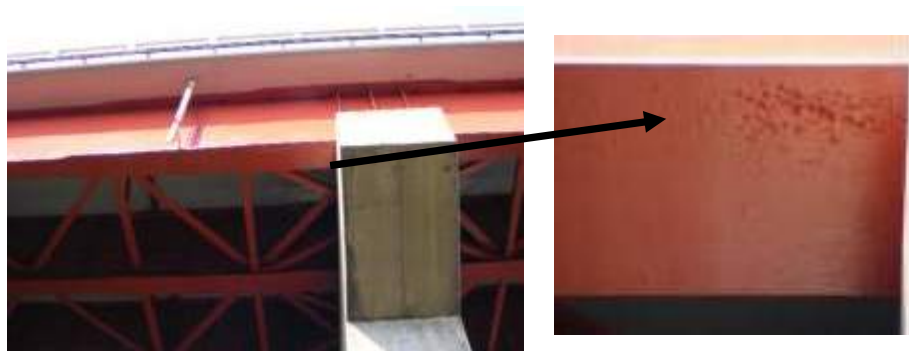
孔食部跡の塗装後の状態（下フランジ下面）
